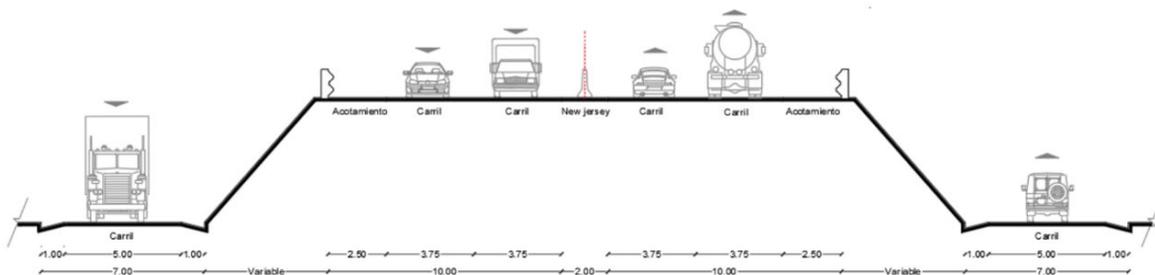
Carretera Guadalajara- Ocotlán/ Sección D-D'
